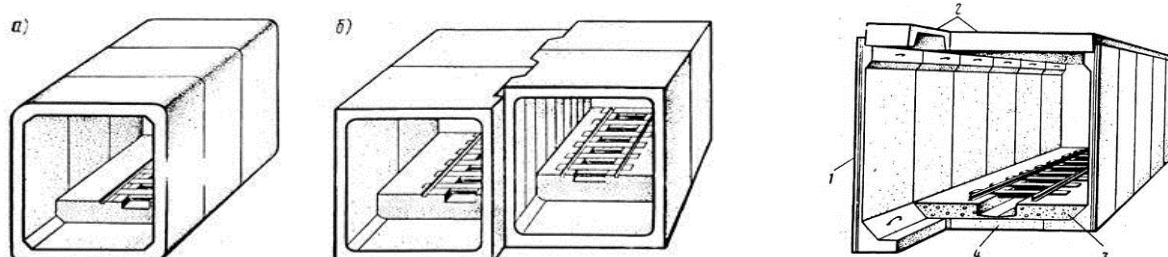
Обделка перегонных тоннелей открытого способа работ из цельных секций: а) для однопутного тоннеля; б) для двухпутного; в) обделка перегонных тоннелей открытого способа работ из сборного ж/б: 1 – стеновой блок; 2 – блок перекрытия; 3 – бетонное основание; 4 – лотковый блок
